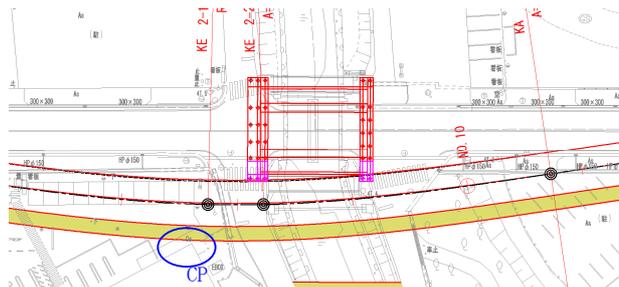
迂回路平面図(第2案：反復施工上流側迂回路案)
